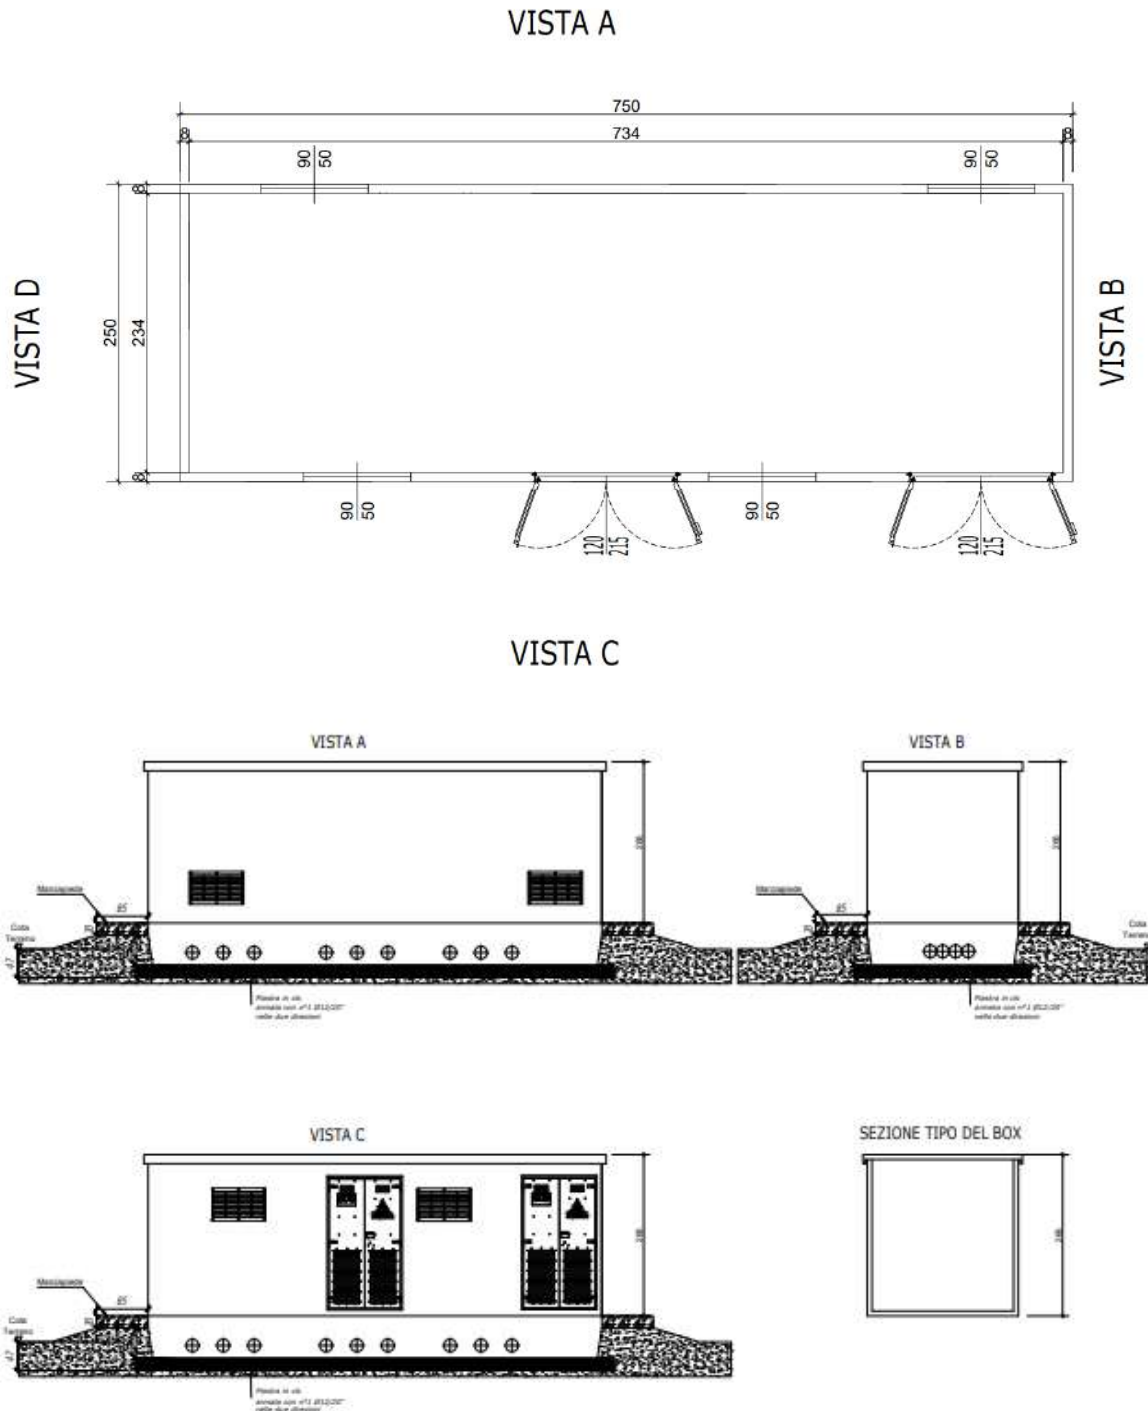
Pianta e Prospetto principale della cabina sottocampo
